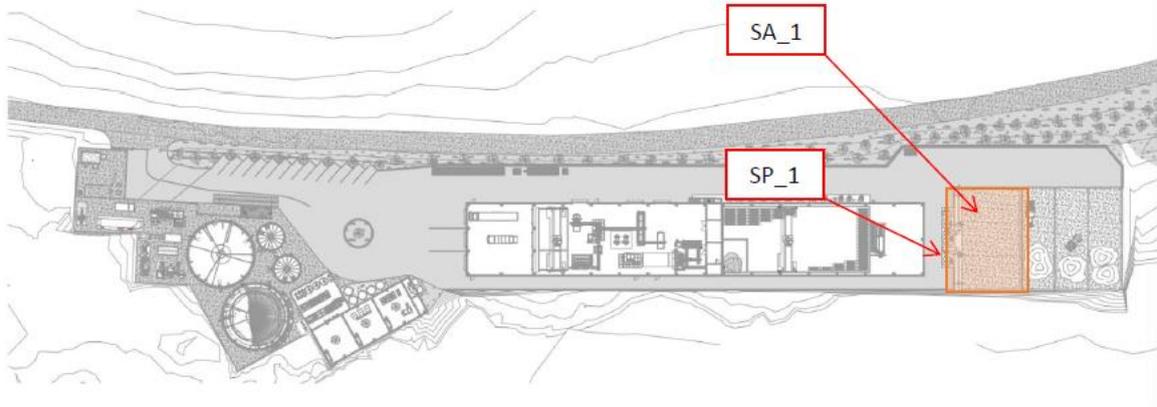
Planimetria con individuazione della sorgente emissiva da biofiltro e essiccatore
